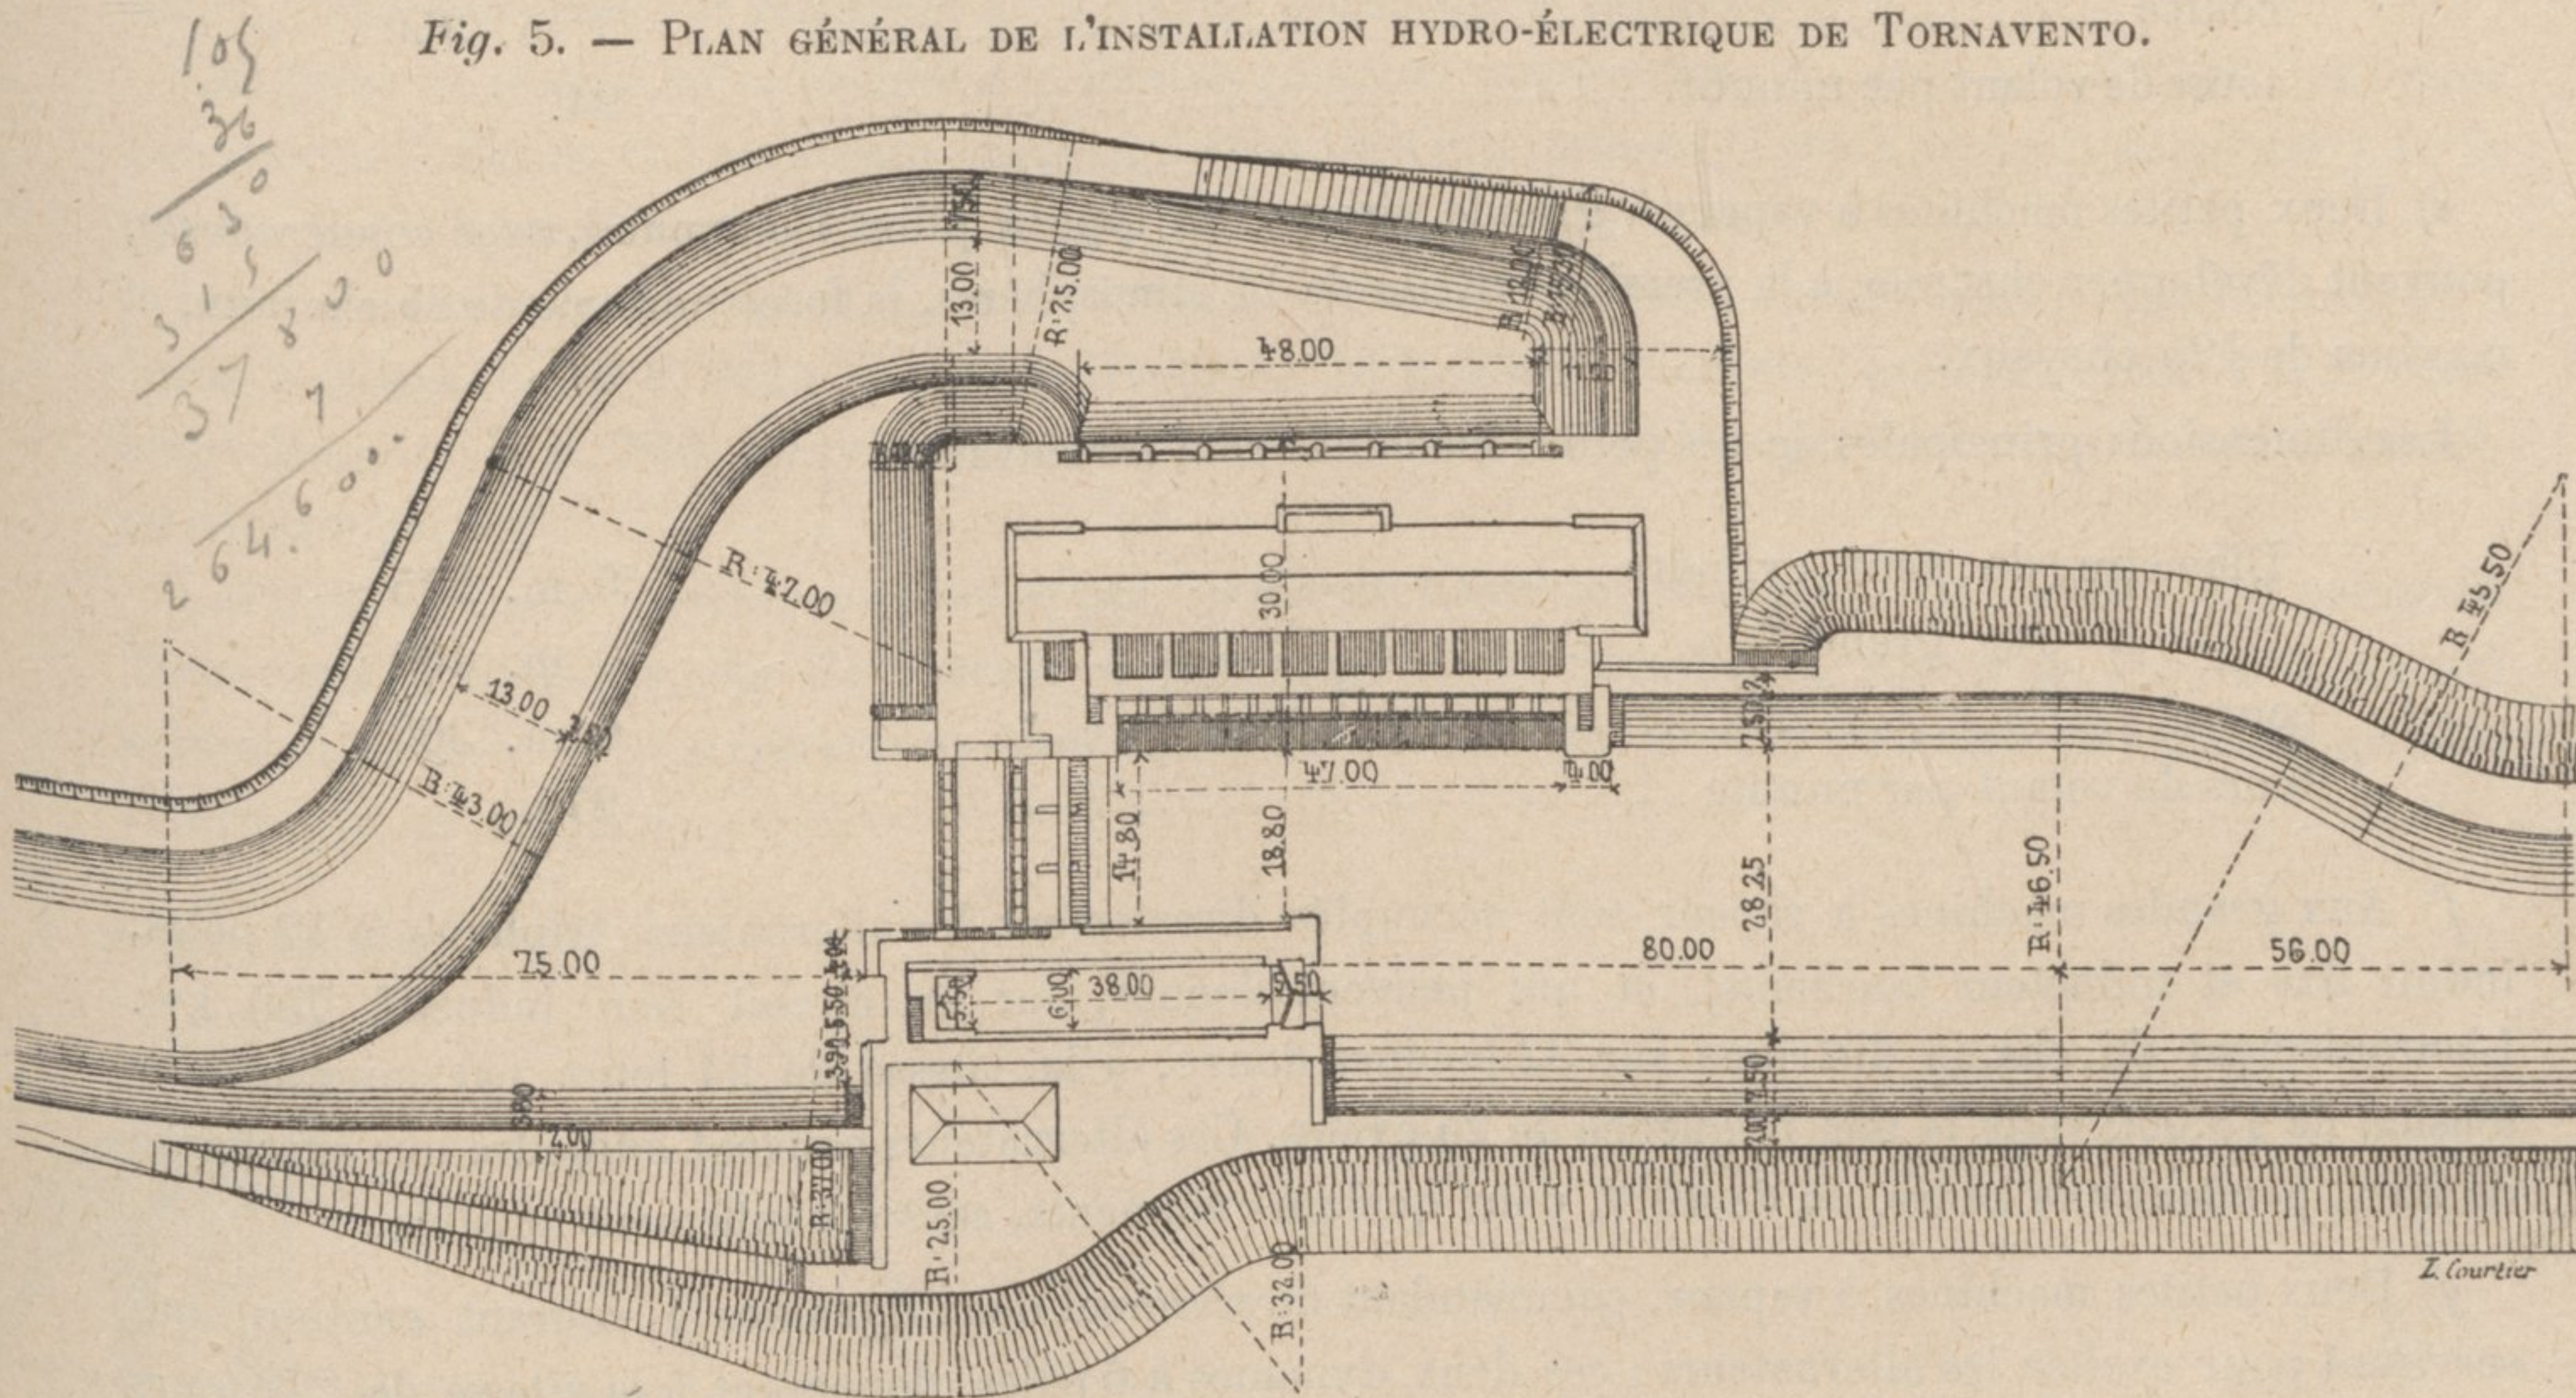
PLAN GÉNÉRAL DE L'INSTALLATION HYDRO-ÉLECTRIQUE DE TORNAVENTO.
